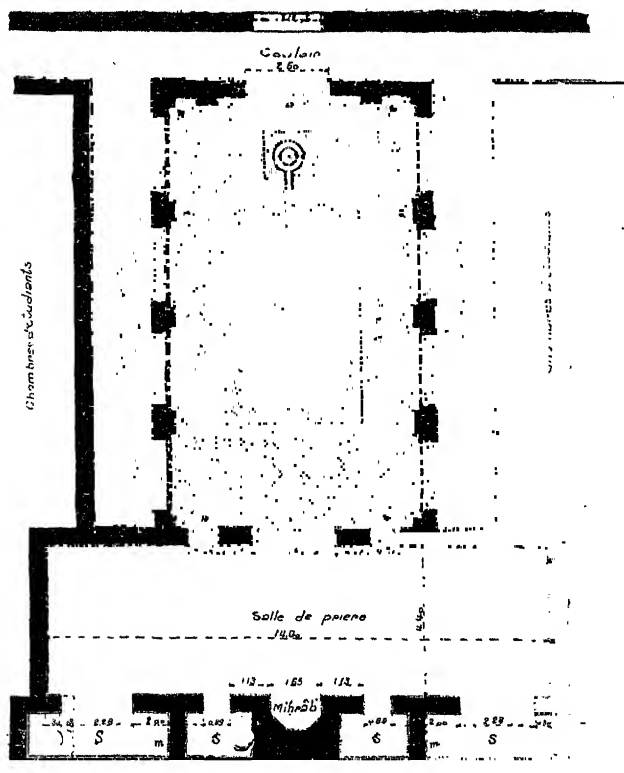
Plan du rez-de-chaussée (atrium et salle de prière)
